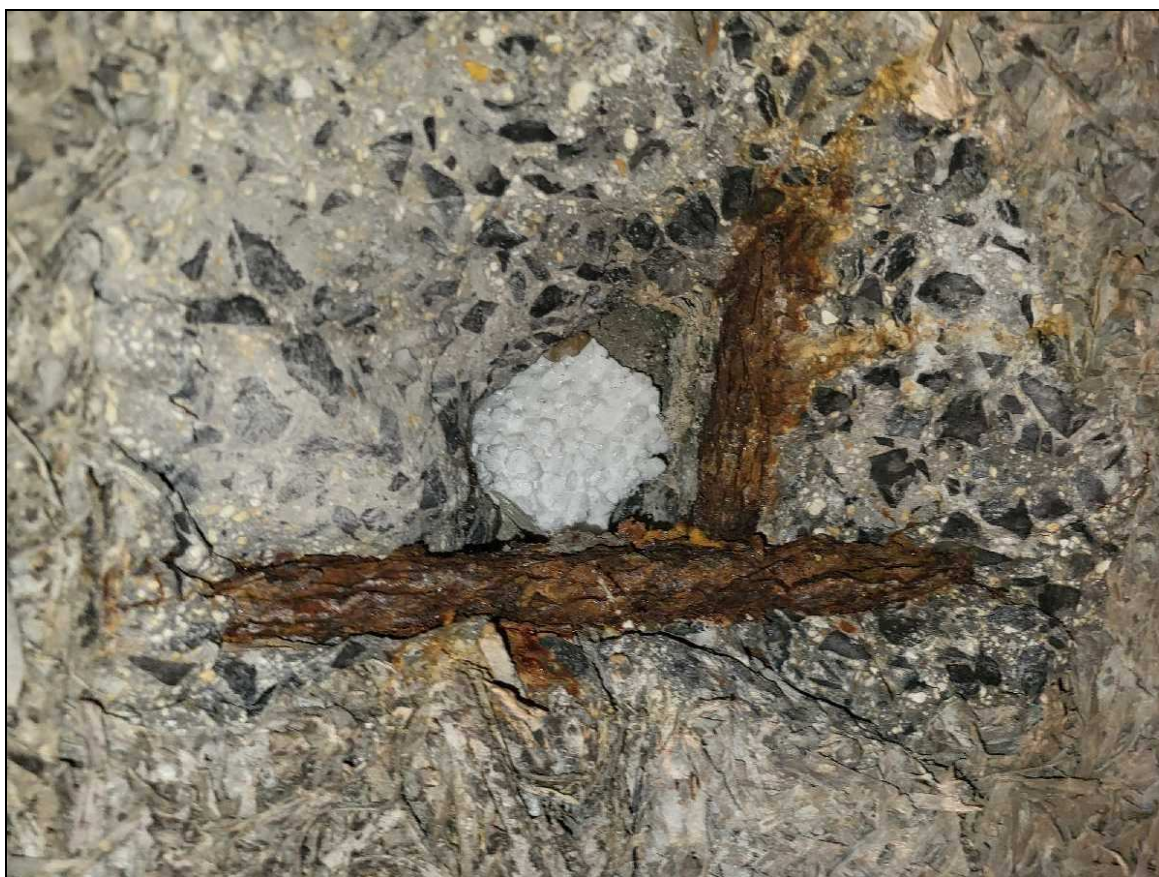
Corrosion avancée des armatures avec éclat de béton suite au percement réalisé
